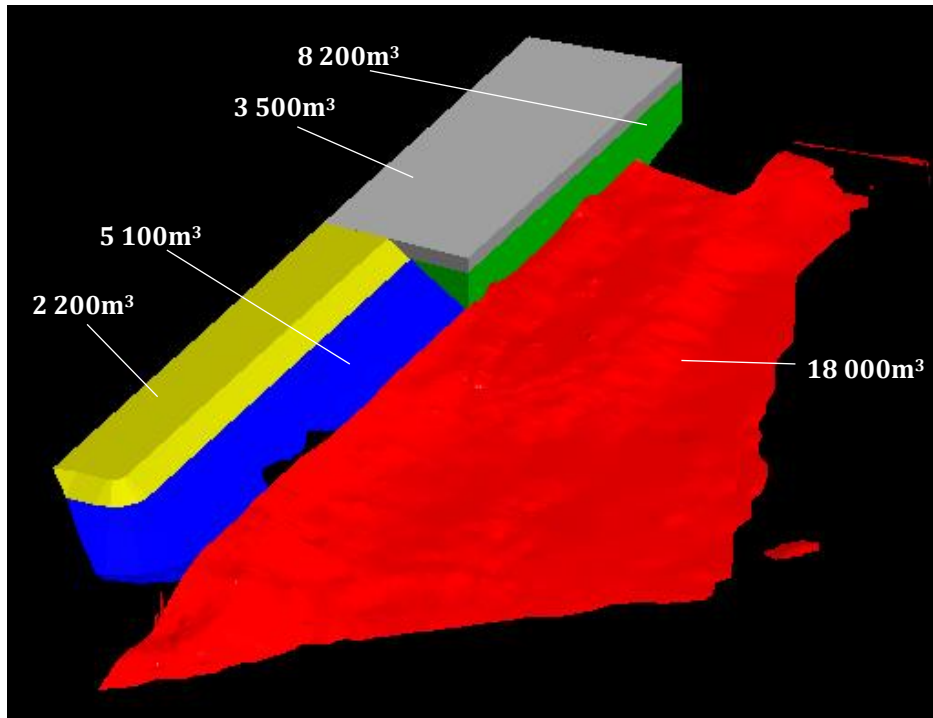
Mudring i indre deler av havnebassenget, planum -13.24 m.
